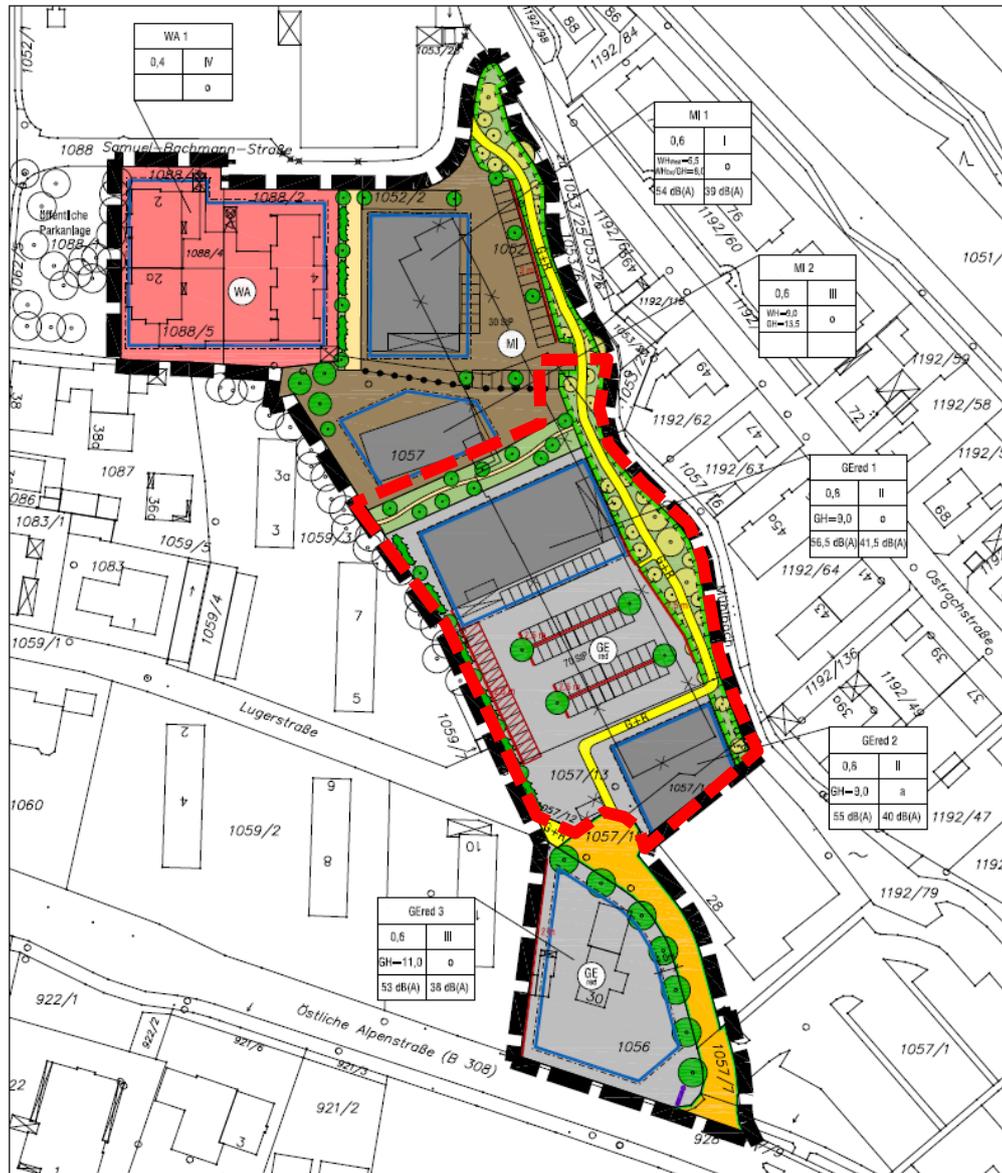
Bestehender Bebauungsplan Stadt Sonthofen Nr. 0070 (1993) mit 0068-1 (2009) und 0070-2 (2009) mit Abgrenzung der 3. Änderung (rot)
